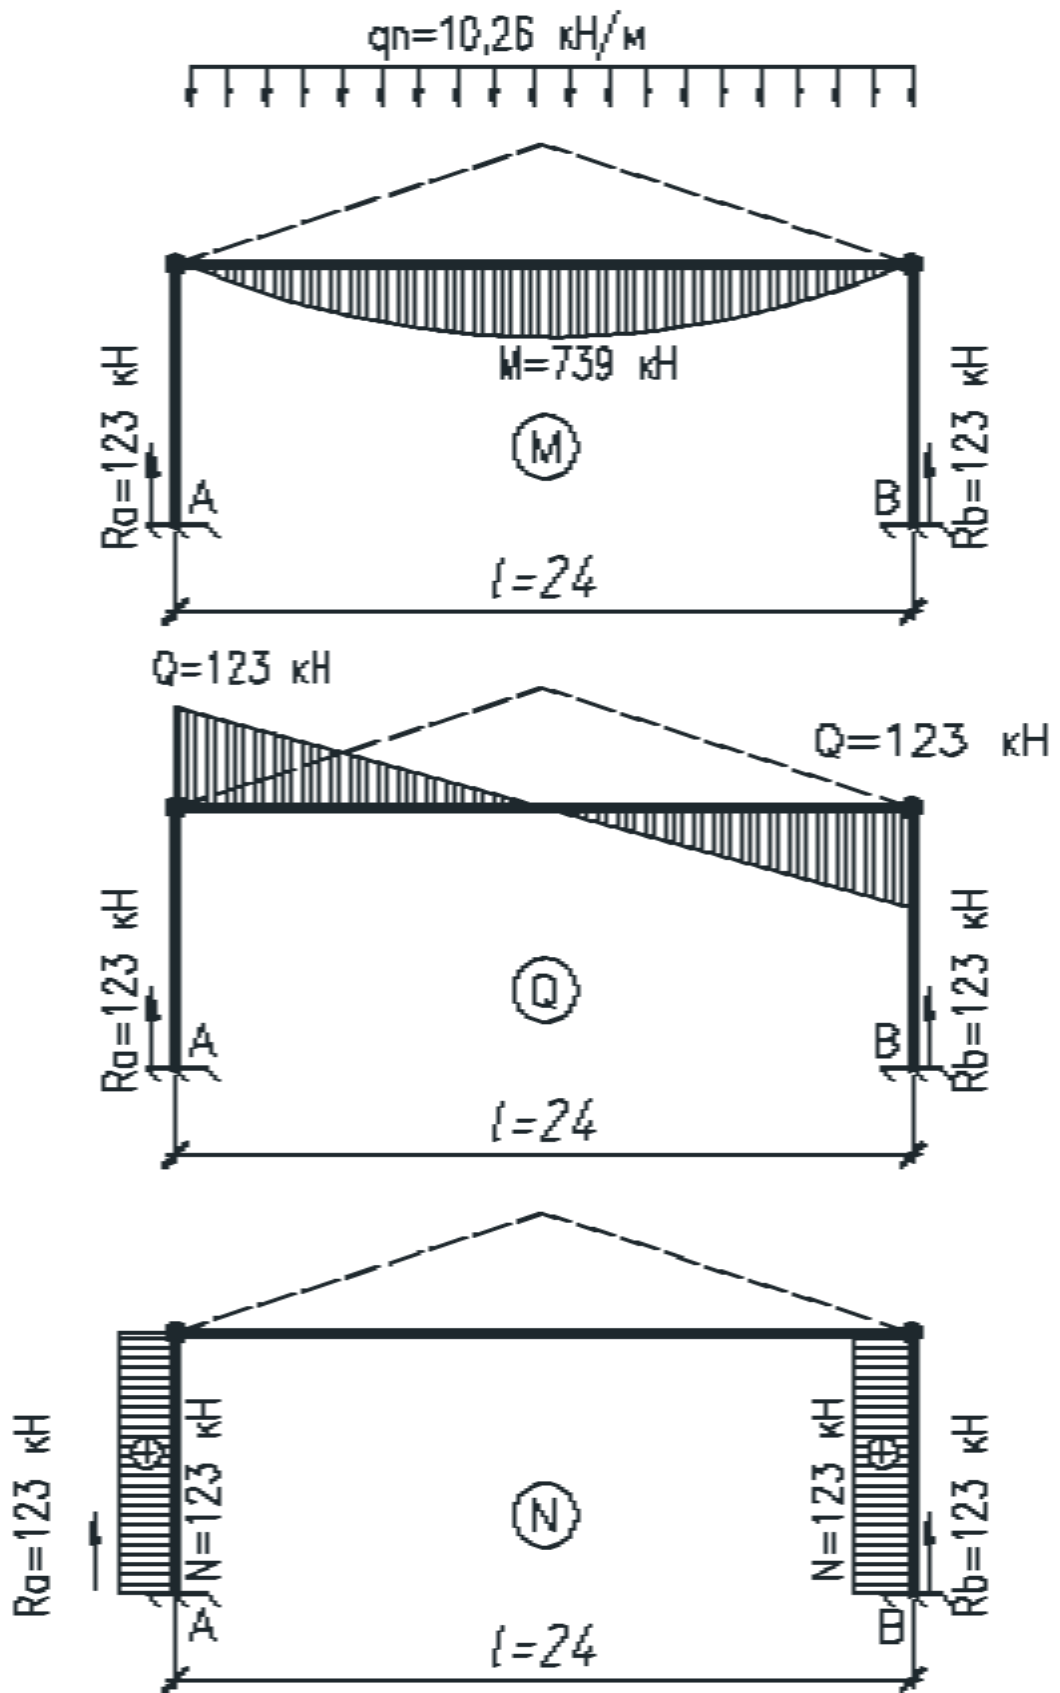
Розрахункова схема поперечної рами каркасу будівлі
